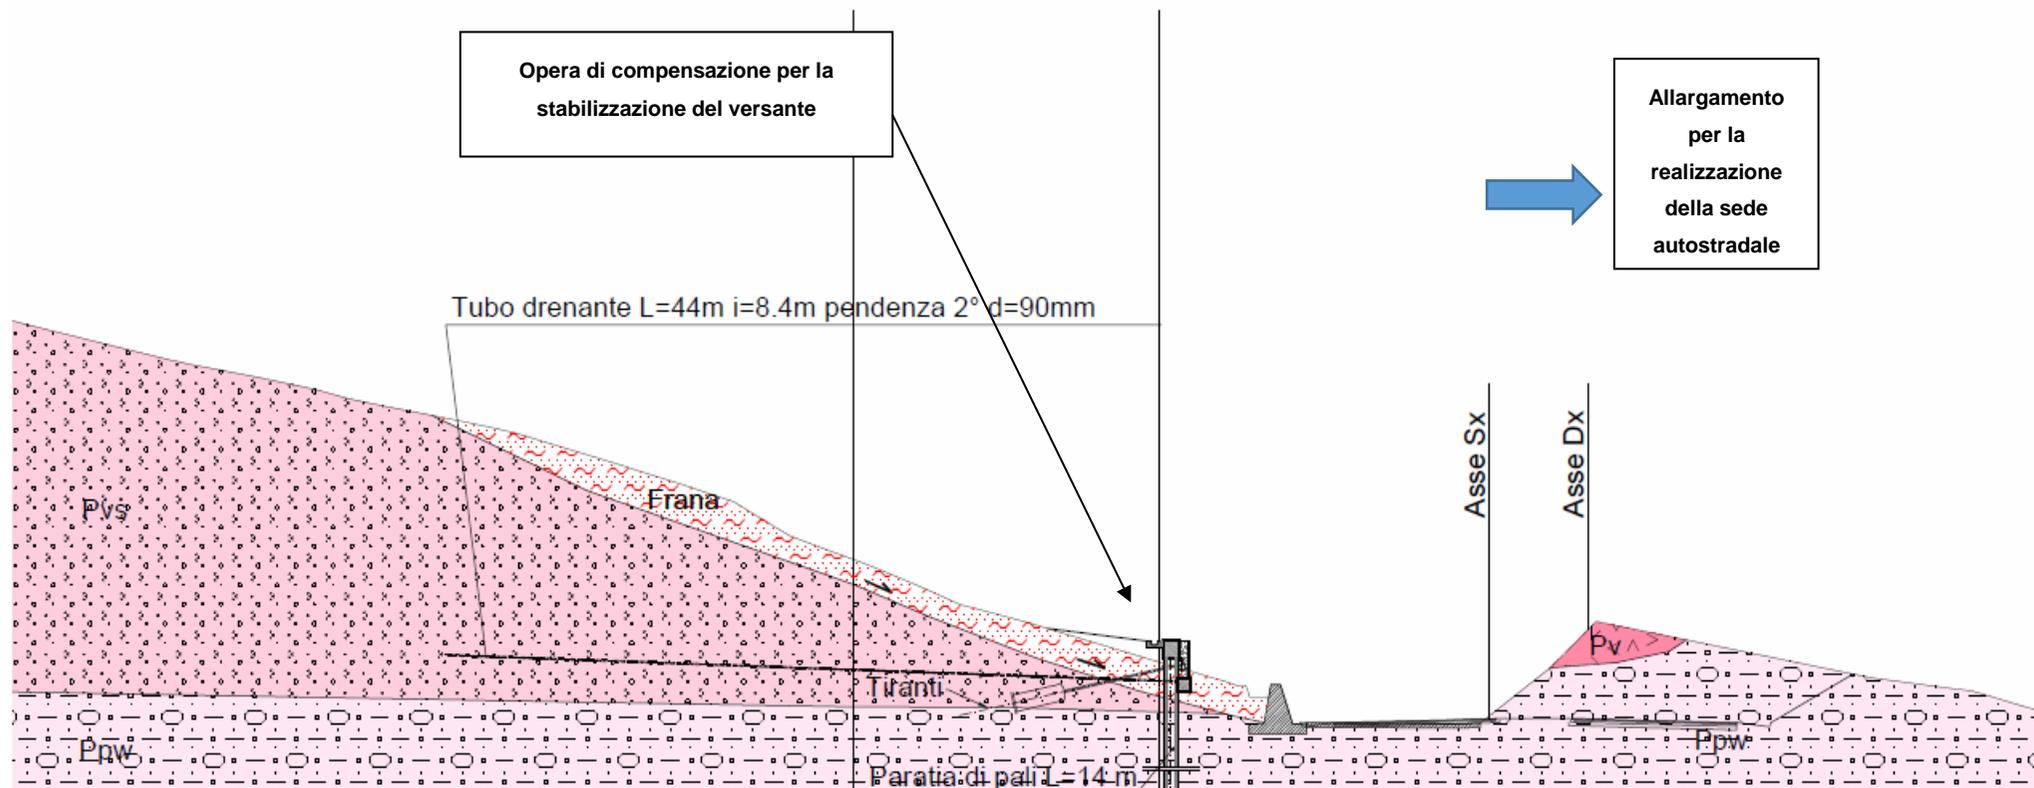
Lotto 5 – Sezione trasversale dell'intervento di stabilizzazione su frana
